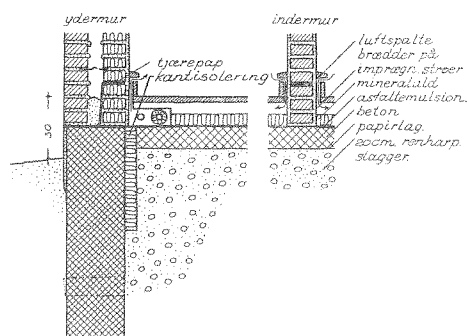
Gulv direkte på jord med varmerør under trægulvet. Gulvet er dermed ventileret, så det holder sig tørt. Under betonpladen er lagt et lag renharpede slagger på 20 cm, så grundfugt ikke kan suges op.
